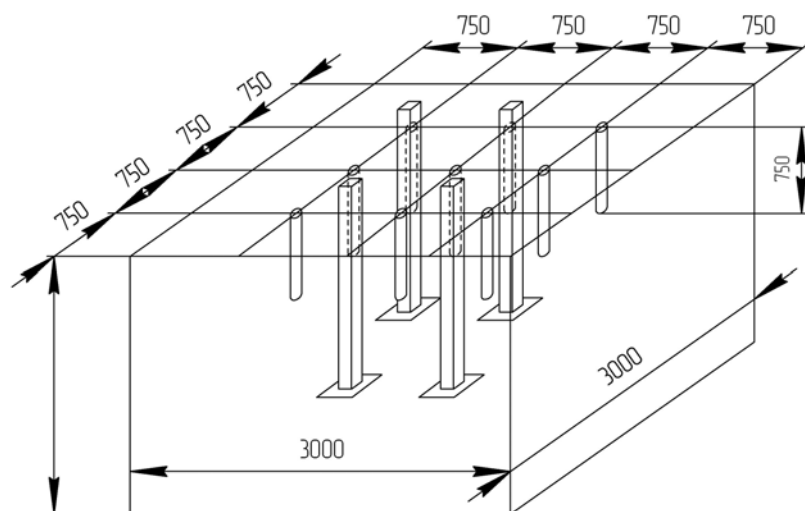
Вариант схемы расположения шпуровых зарядов при рыхлении фундаментов
